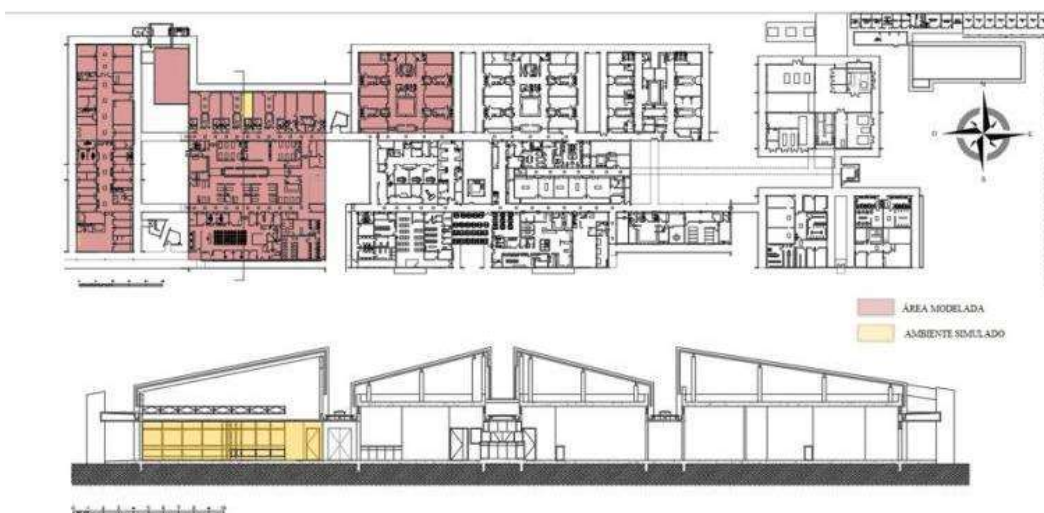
Planta baixa e corte do HMLJ, autores adaptado de Secretaria Municipal de Urbanismo.
